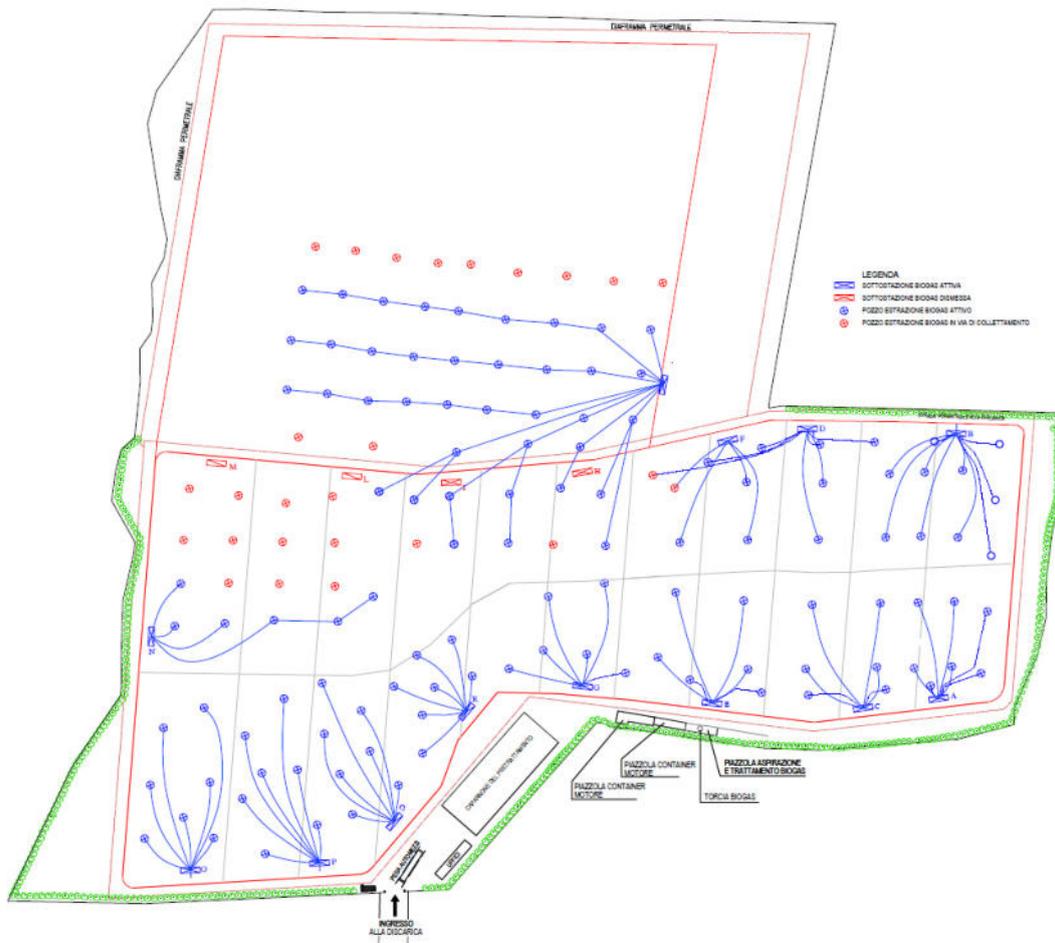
Planimetria stato di fatto impianto di captazione biogas al 30/12/2018
